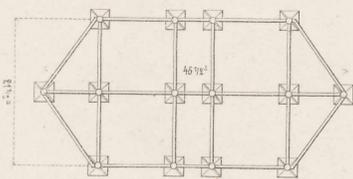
Grundriss der Pfeilerplatte nach G.H.
